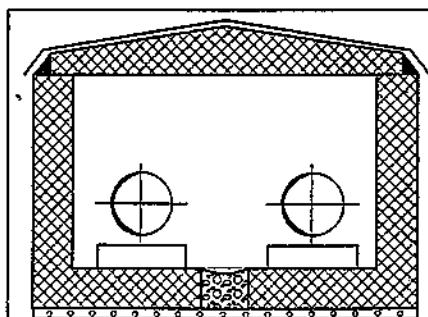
Canal semicirculabil cu elemente prefabricate din beton armat în formă de L.
